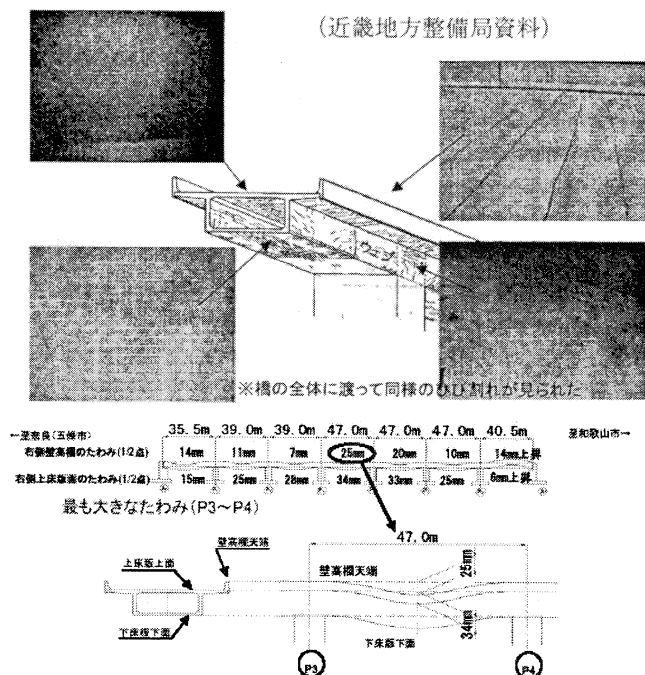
垂井高架橋で発生したひび割れとたわみ
